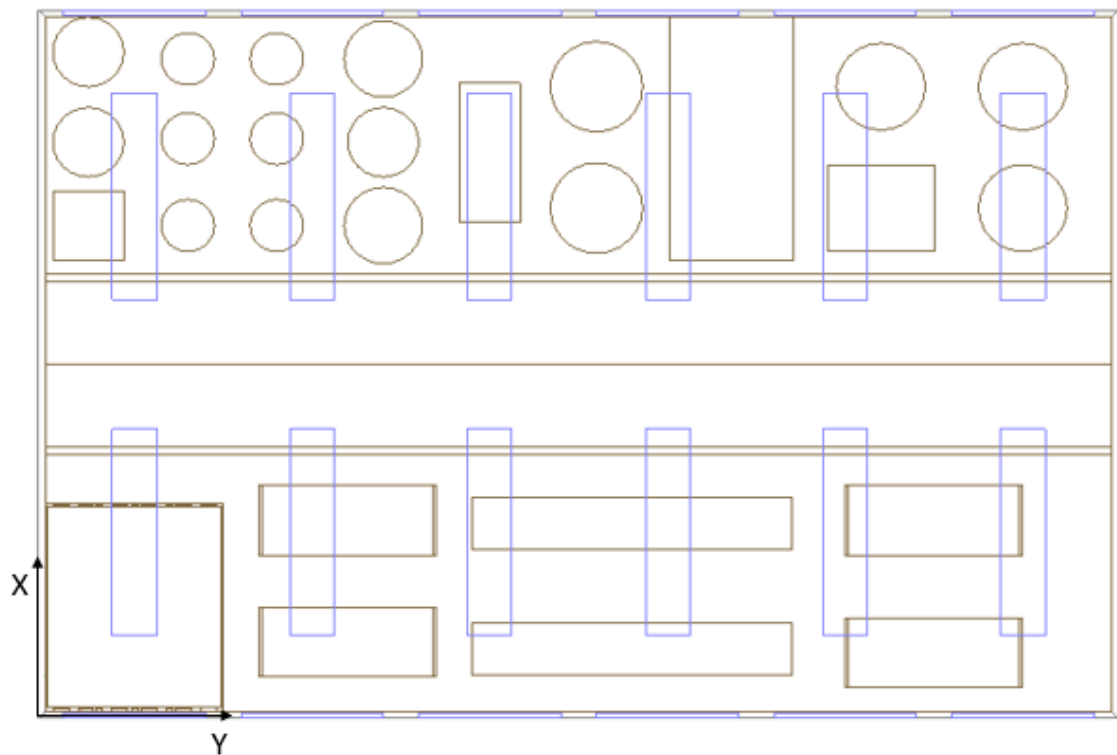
Vista de la planta de la nave industrial, propuesta 1. Fuente DIALux.
